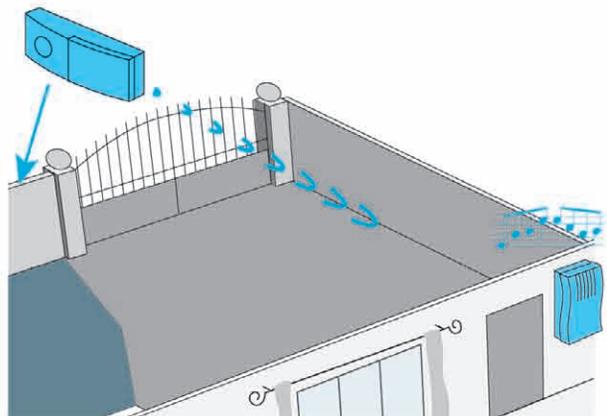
Raccordement d'une sonnette ou d'un carillon
